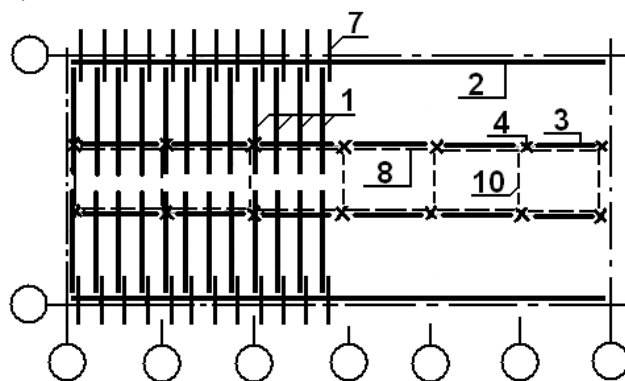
Устройство стропил в зданиях с продольными несущими стенами
